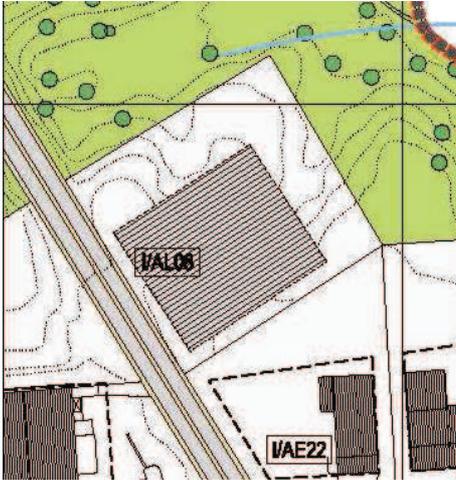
Extracto da Planta de Implantação do PPIIP, em vigor, Parcela I/AL08 - Lote 37
